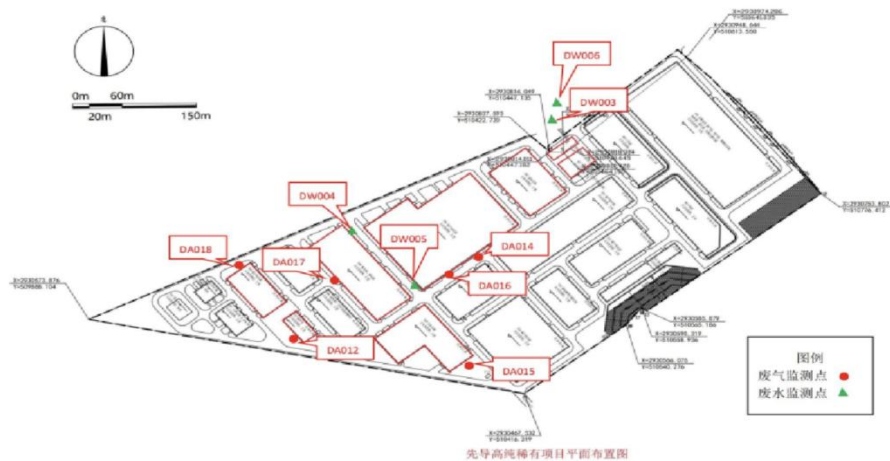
高纯稀有金属项目排放口位置示意图
